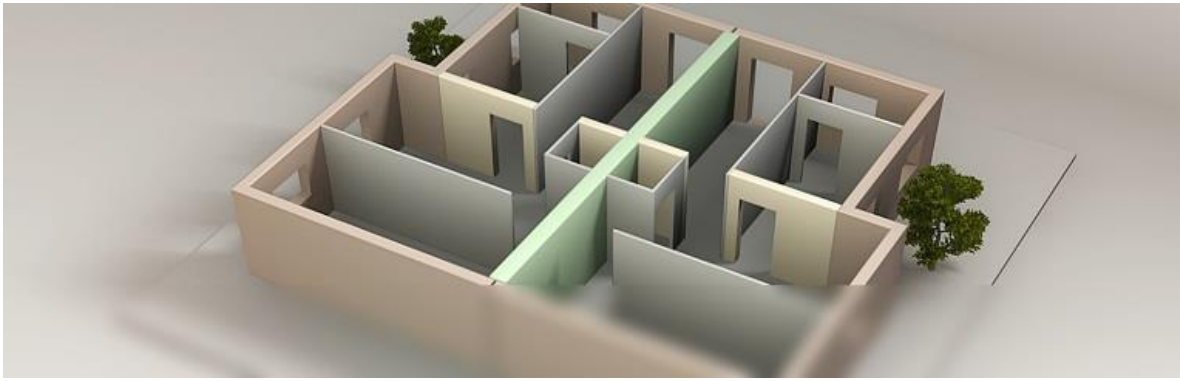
Cubierta, Muro medianero y Muro divisorio (volcan, 2014) (obrasweb, 2015) (redestrategia, 2015)
